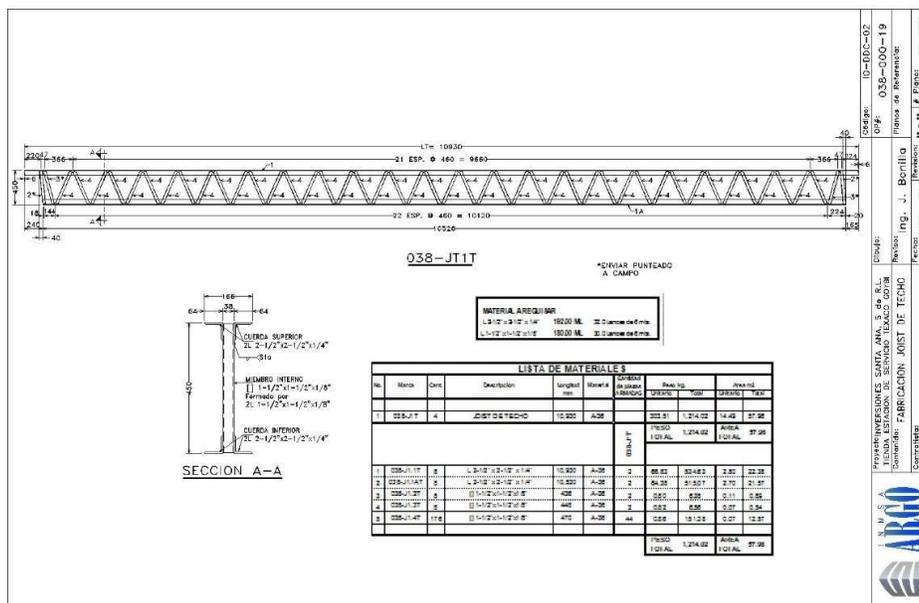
Fabricación de viga joist, Tienda de conveniencia
